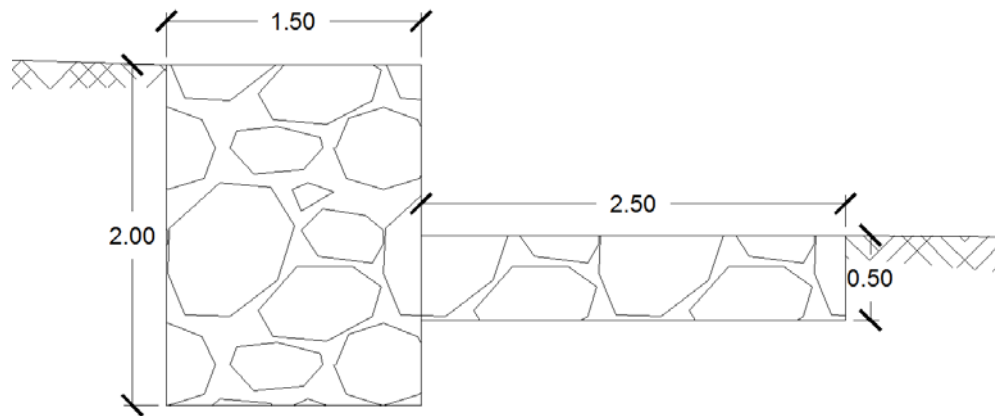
Detalle del muro guardanivel, sin escala.
